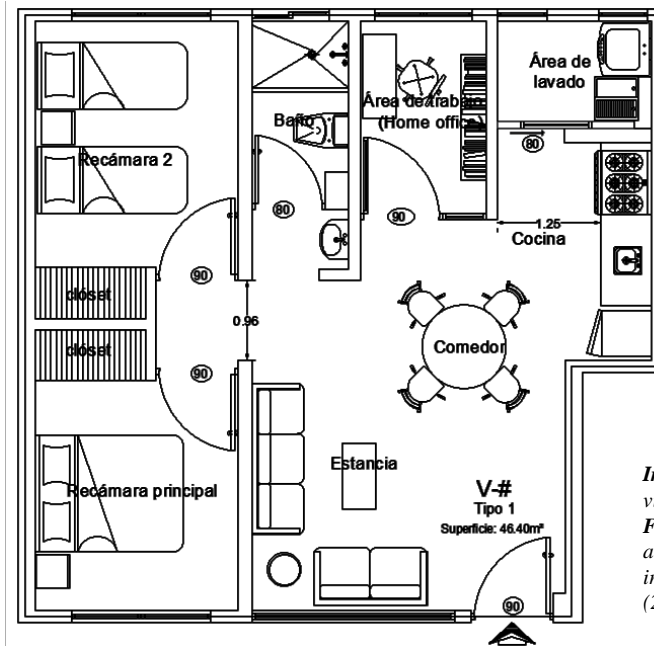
Vivienda Tipo 1 del Conjunto de vivienda propuesto en la Col. Morelos.
